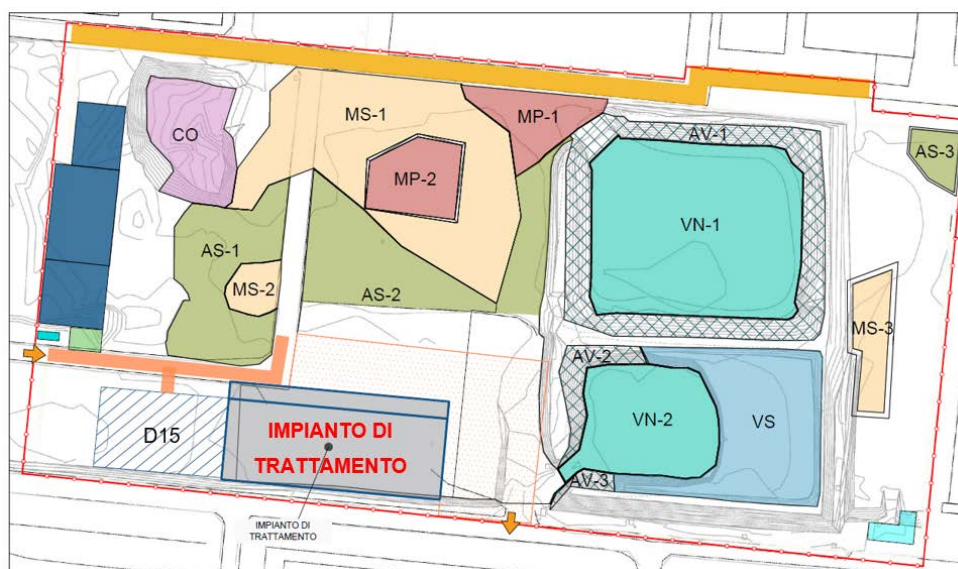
Planimetria area palte con individuazione delle zone di scavo, del deposito preliminare D15 e del capannone destinato ad ospitare l'impianto di trattamento
